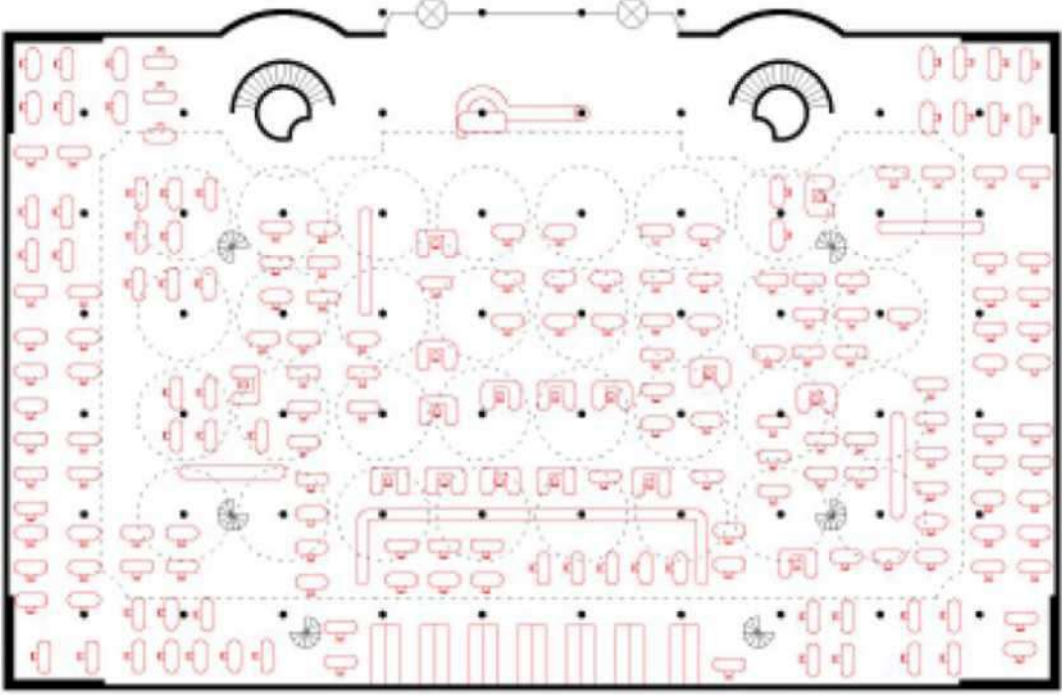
Wainwright Binası Planı -Louis Sullivan (Url-4).
